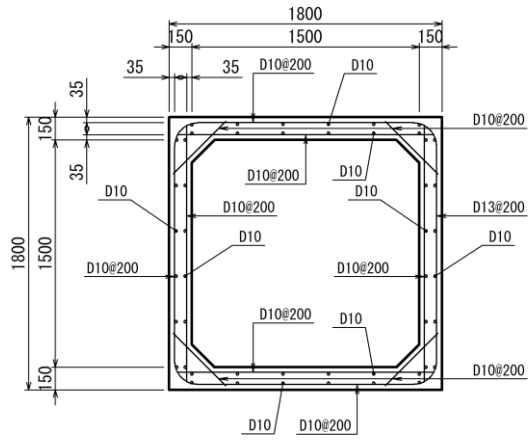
(1) 屋外排水路 (防波壁横断部) の概略断面図
